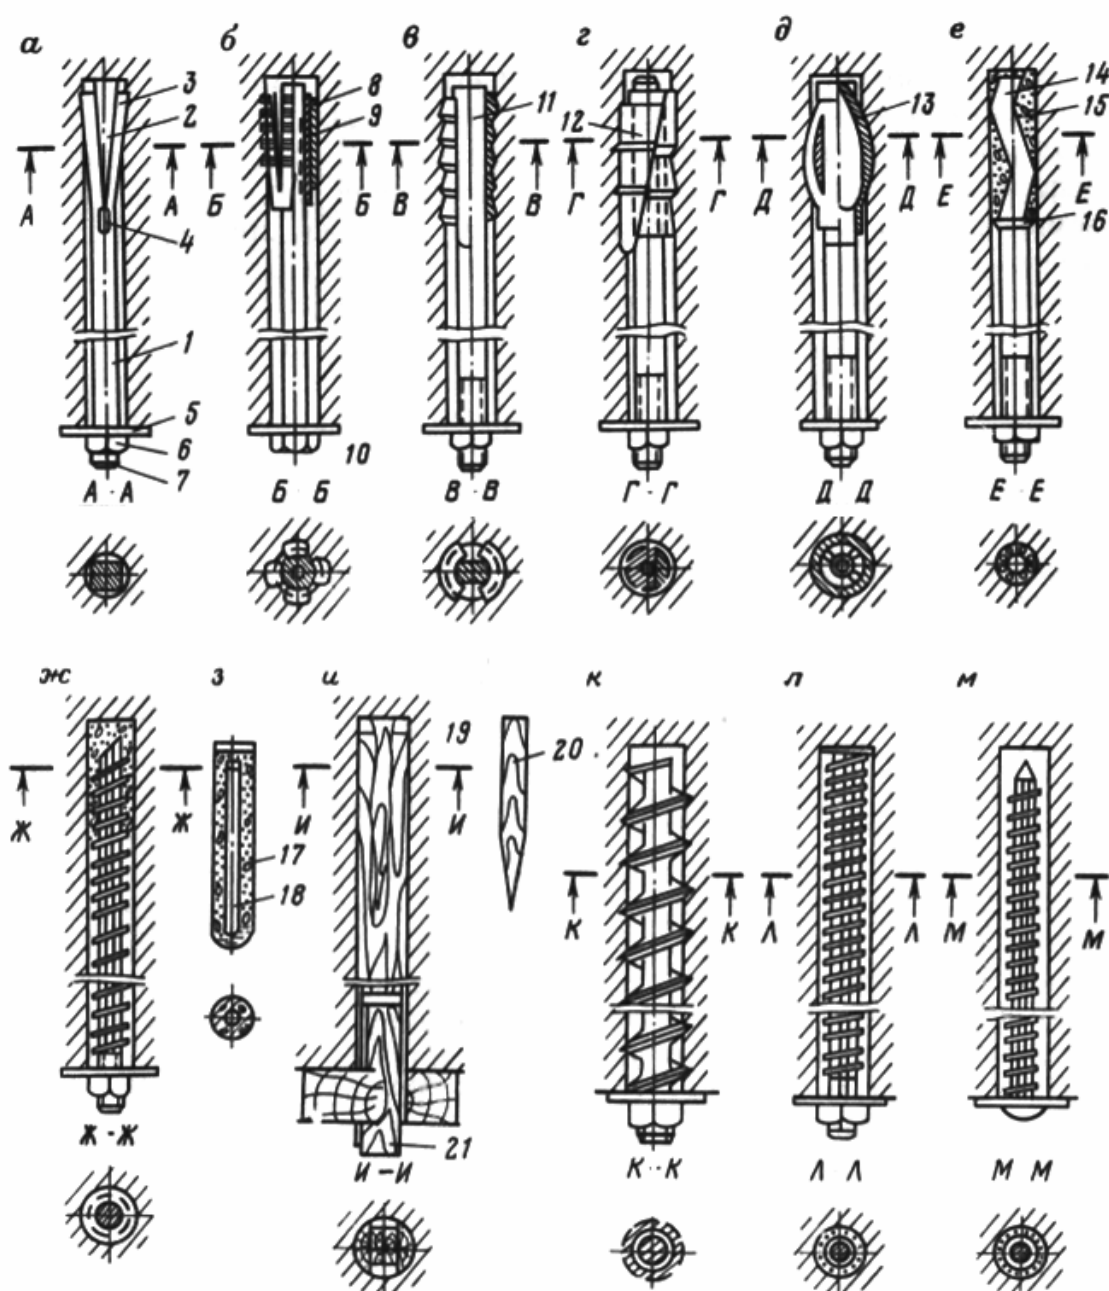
Конструкции анкеров: а – клинощелевой; б, в, г – распорные; д – взрывораспорный; е, ж – армобетонные замковые; з – ампула; и – деревянный клинощелевой; к – винтовой; л, м – сплошные армобетонные; 1 – стержень; 2 – клин; 3 – усы; 4 – щель; 5 – опорная плитка; 6 – гайка; 7 – контурный конец; 8 – конусная гайка; 9 – гильза; 10 – болтовая головка; 11 – клиновидная головка; 12 – клиновидный сегмент; 13 – трубчатая головка после взрыва; 14 – вилнообращый глубинный конец; 15 – бетонная или полимербетонная пробка; 16 – уплотнительное кольцо; 17, 18 – секции со смолой и отвердителем; 19, 20 – глубинные клинья; 21 – контурный клин
